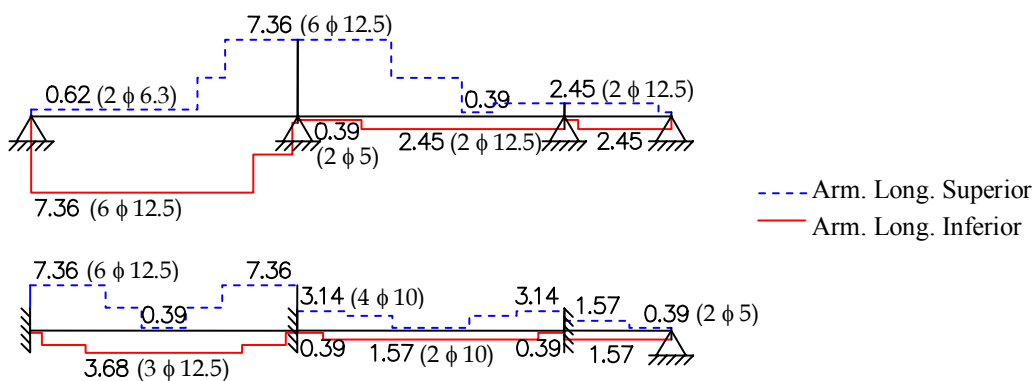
Diagrama de armadura longitudinal adotada do Exemplo 4.
